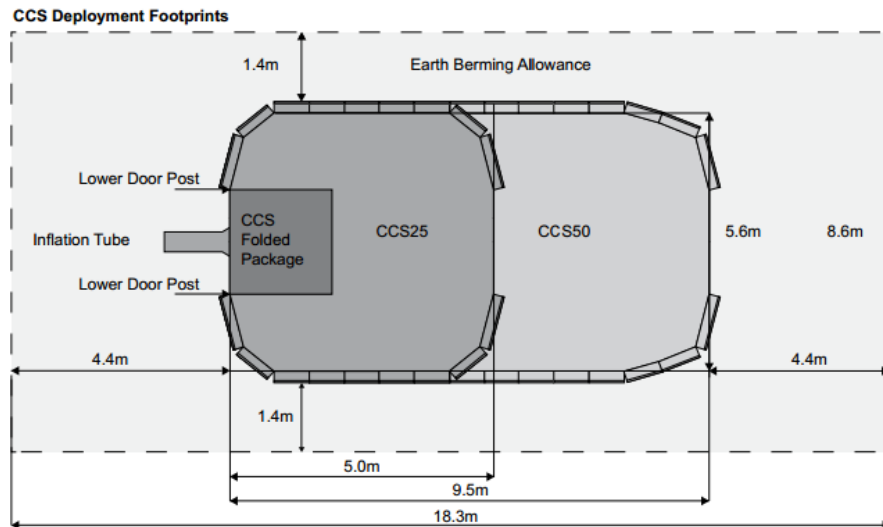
Planta de Concrete Canvas. Fuente: Concrete Canvas, <http://www.concretcanvas.com>
